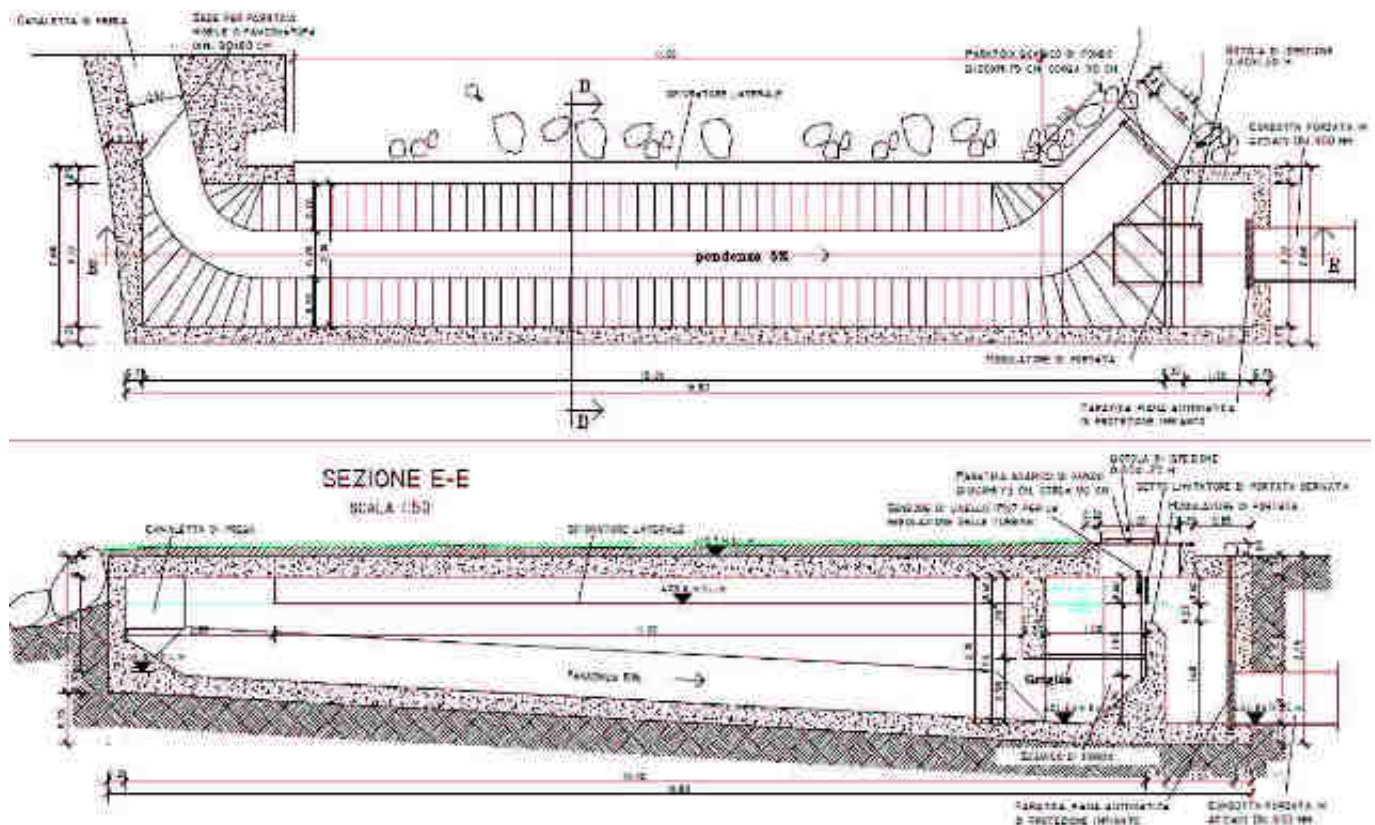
pianta e sezione longitudinale opera dissabbiatrice-modulatrice
